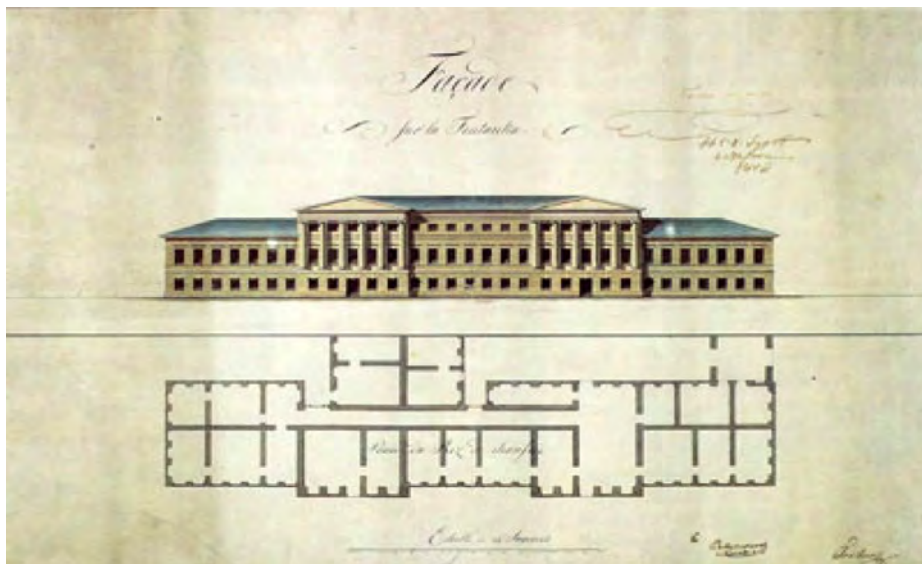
A. Betancourt levantó los planos y realizó la construcción de la fábrica de papel moneda en 1816-1818 a orillas del río Fontanka.
